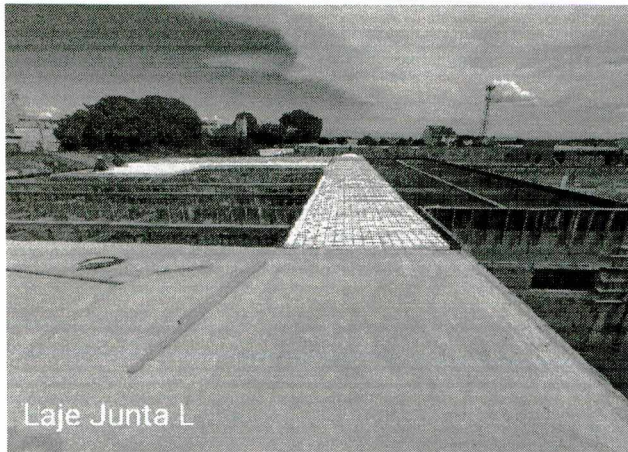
a 47: Execução de alvenaria de primeira e segunda etapa; concretagem da laje e execução de alvenaria da platibanda.
